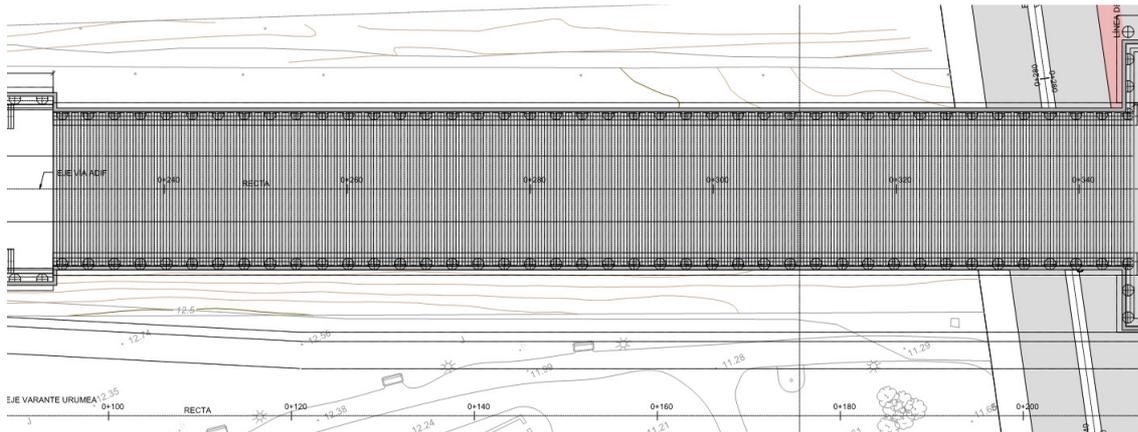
Planta del tramo 2. Cobertura andenes ADIF
